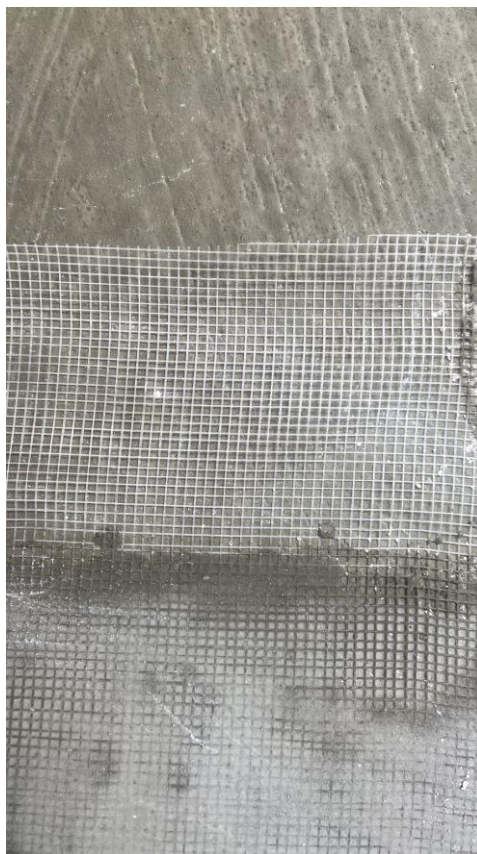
Aplicação de tela estruturante em cima da primeira camada de impermeabilização, com início da aplicação da segunda demão.
